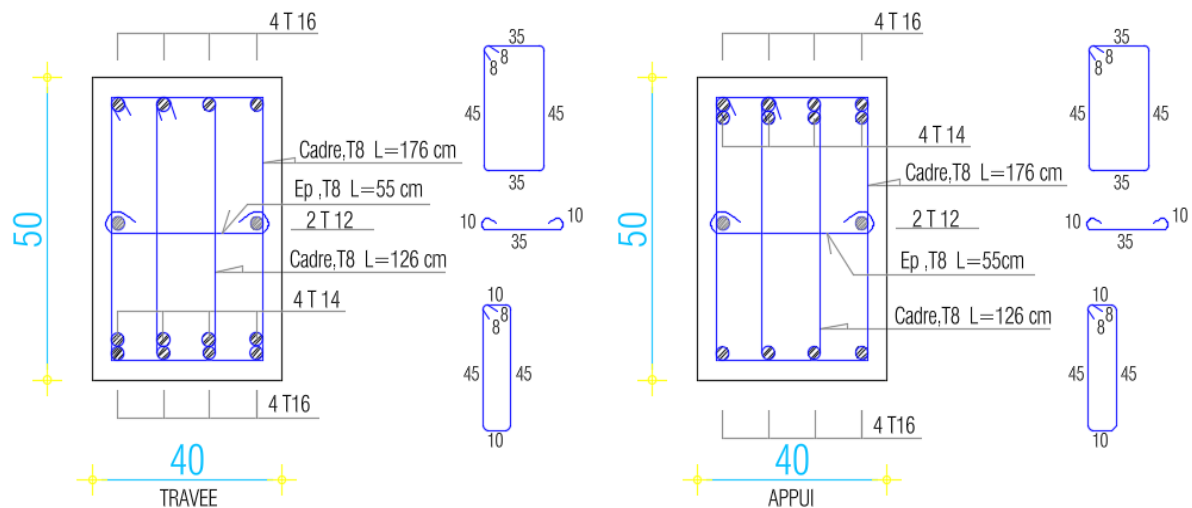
Schéma de ferrailage de la poutre principal 40x50 sur travée et appui
